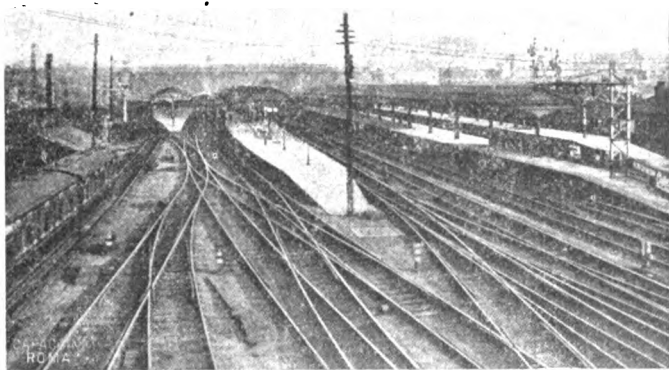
Nuova stazione Snow-Hill di Birmingham. - Vista del piazzale interno.
